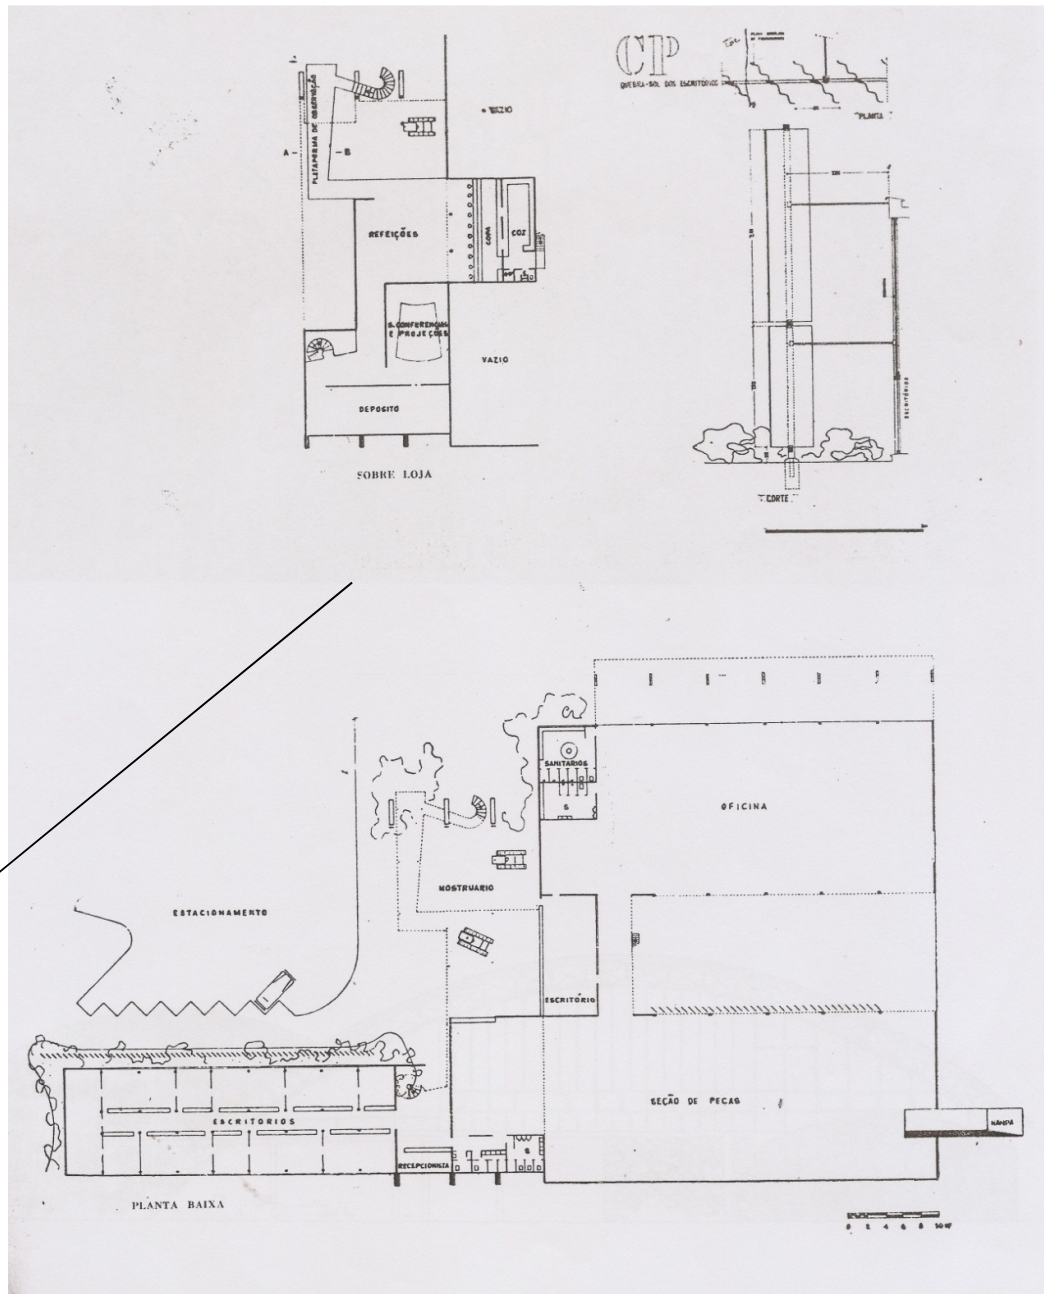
A – Plantas baixas dos pavimentos térreo e sobreloja – detalhe do brise-soleil
